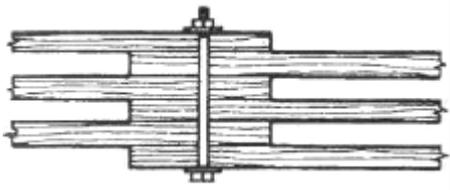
Unión emperrada sometida a cizallamiento múltiple
